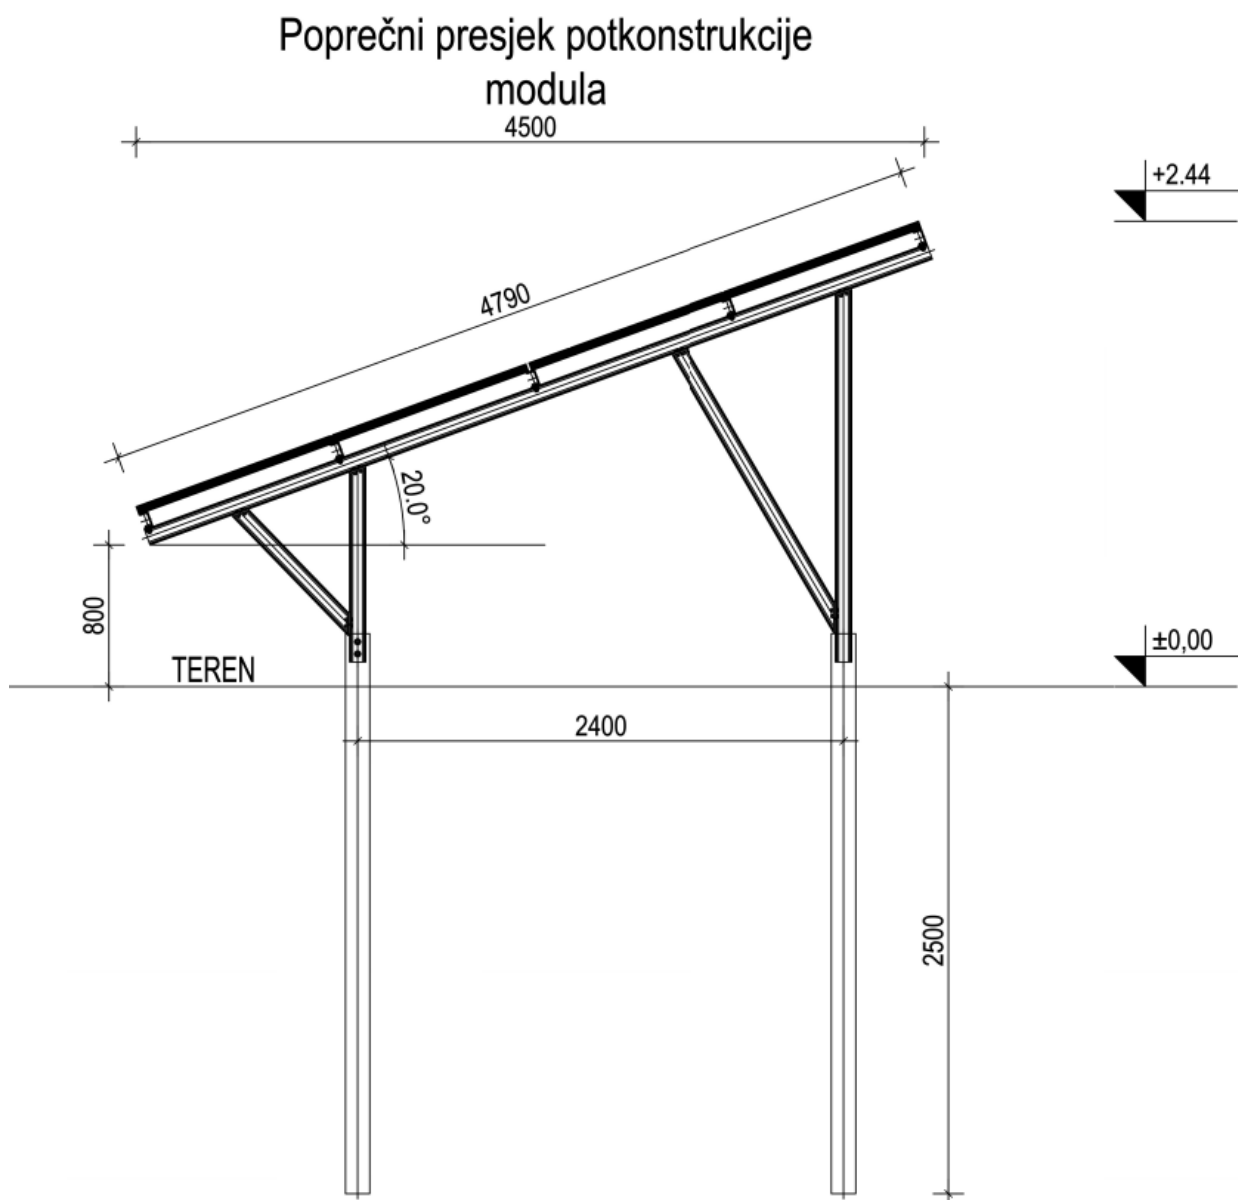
Tipični detalj montaže potkonstrukcije FN modula na stjenovitoj podlozi
